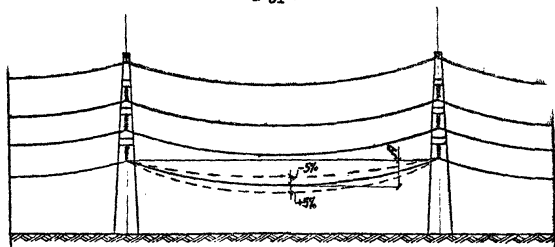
Нормы и допуски на монтаж проводов.
